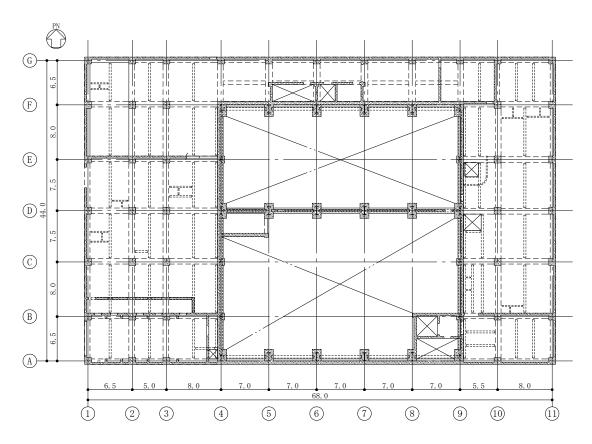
3 階平面図 (0. P. 38. 3) (単位:m)
